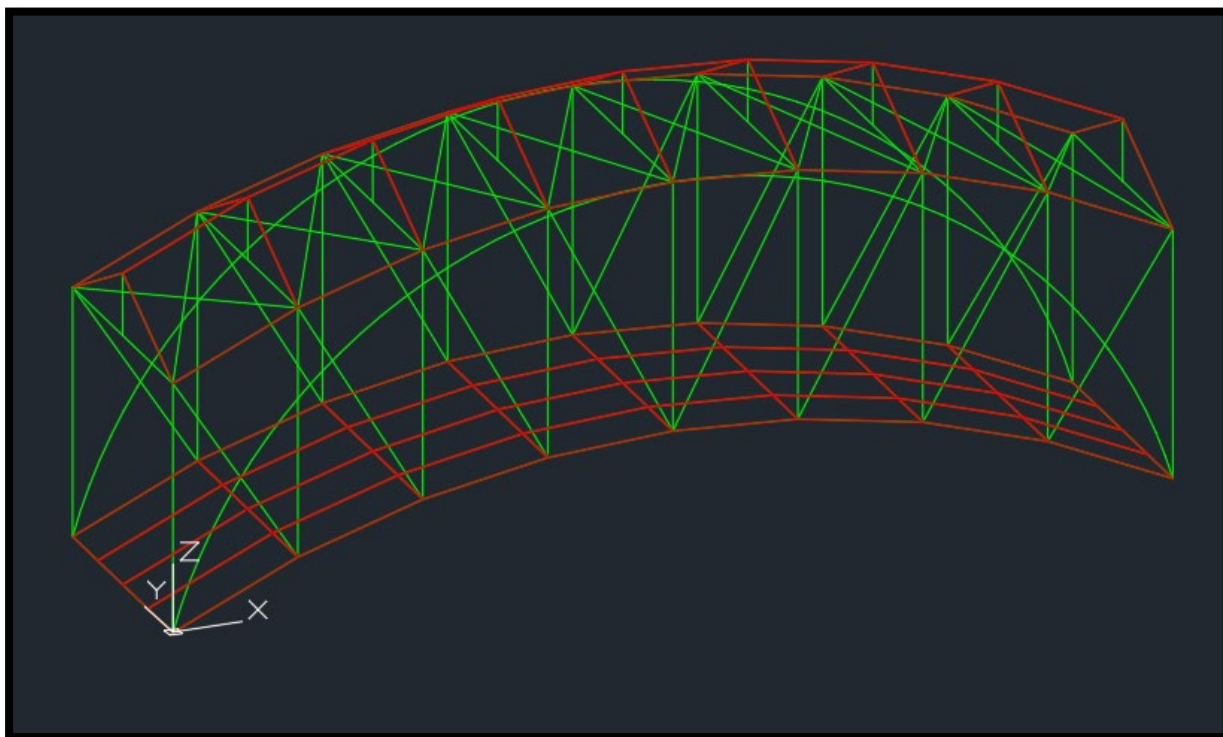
Plano Predimensionamiento AutoCAD 2025 - Estructura en Eje 0,0,0
